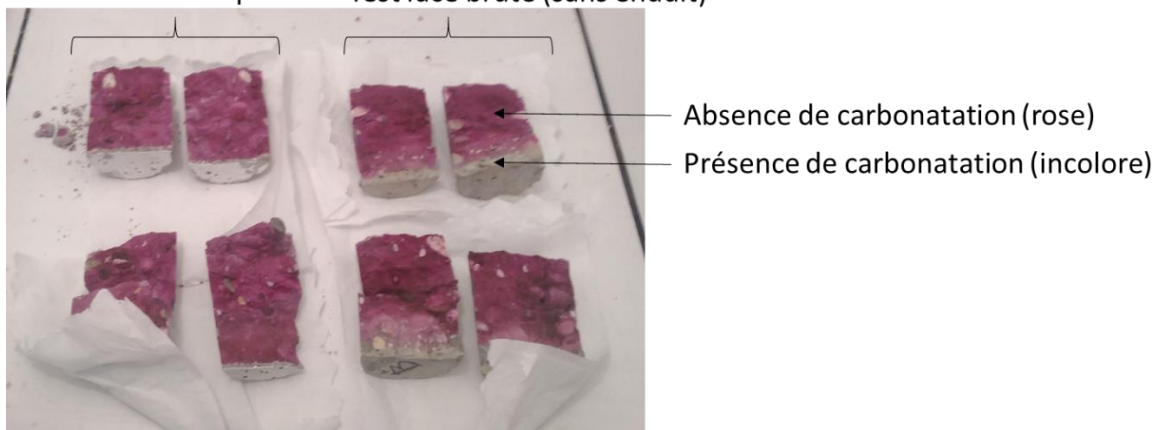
Test à la phénolphthaléine sur deux éprouvettes de la poutre PL2
